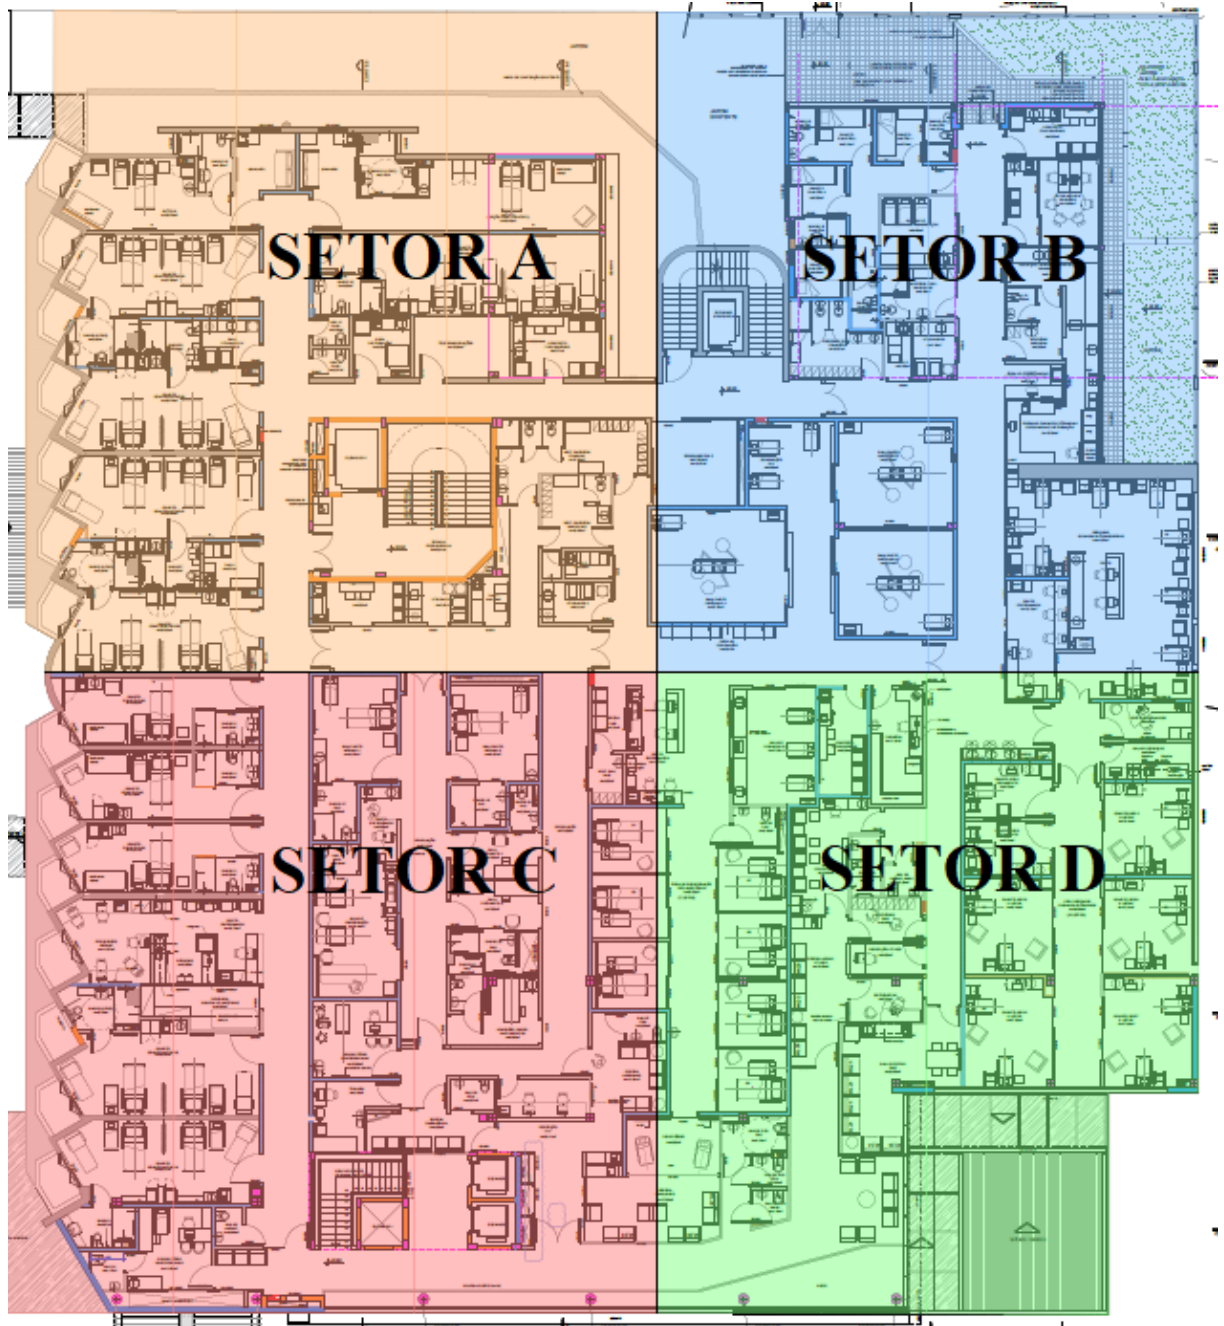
Zonas de trabalho existentes na obra – Terceiro Pavimento
